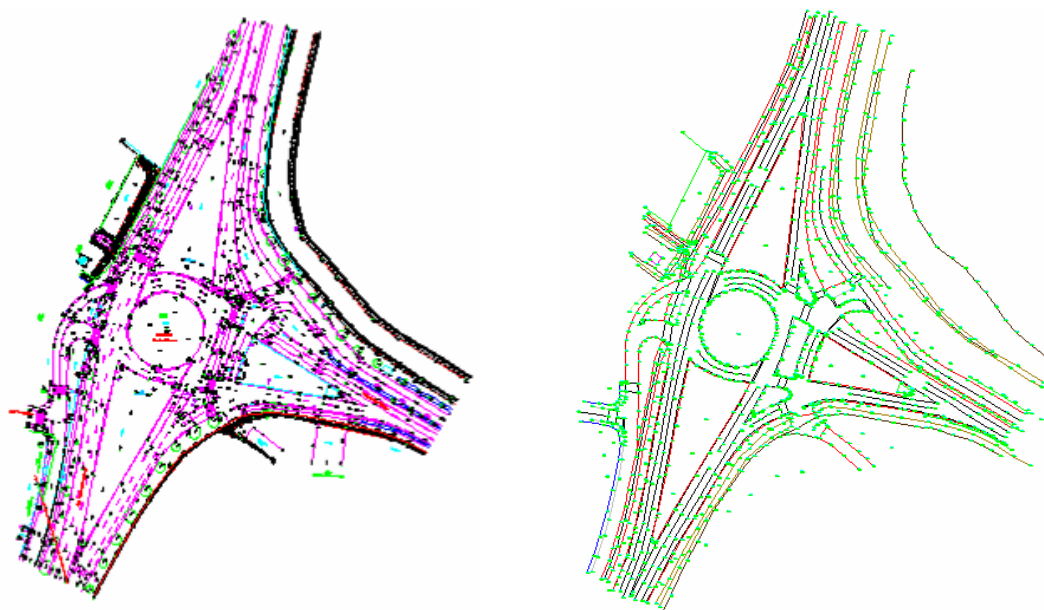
Plan topographique complet (à gauche) et plan photogrammétrique (à droite) (Source : Unité Topographie)
